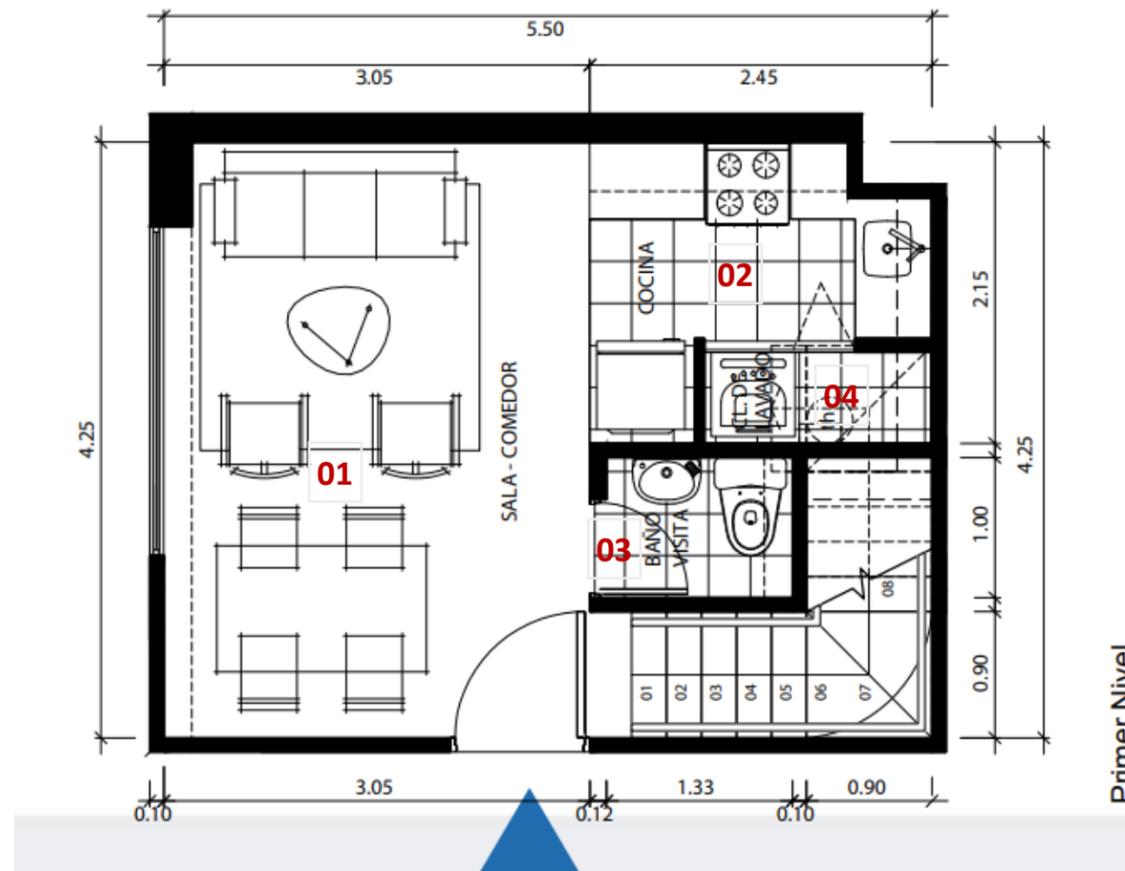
Plano arquitectónico tipo D. Primer nivel. Fuente: <https://initalia.pe/centric-petit-thoars/>
